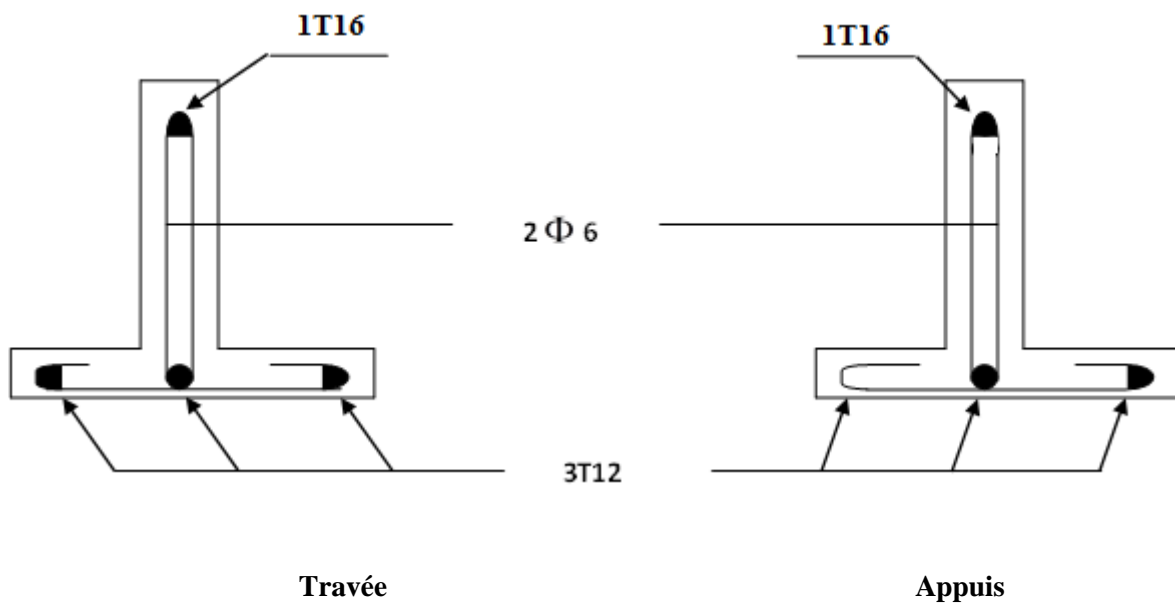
Disposition constructive des armatures des poutrelles à 6 travées
